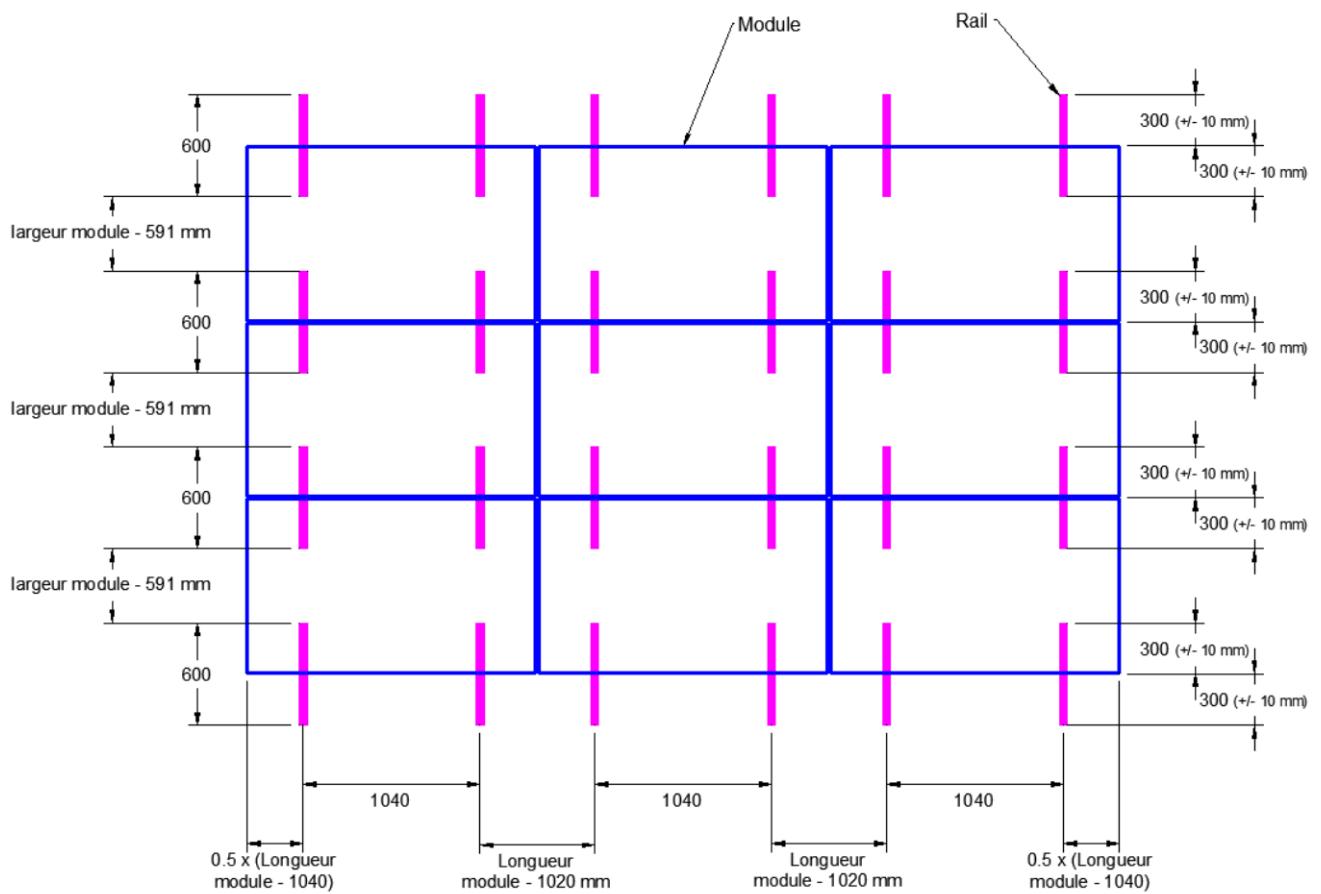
(suite) - Assemblage rail / kit d'inclinaison / module
